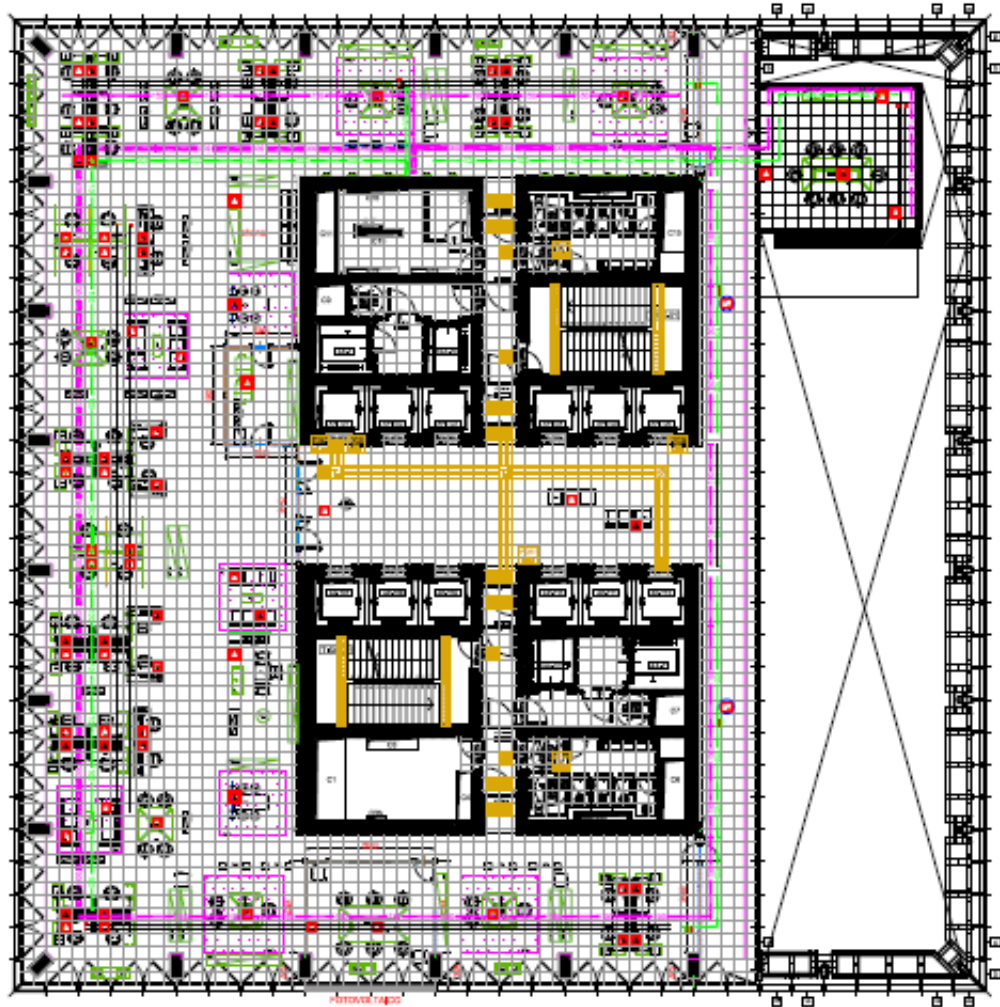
Planimetria impianti a pavimento livello 4 Torre della Regione - Fonte: [vedi 17]
